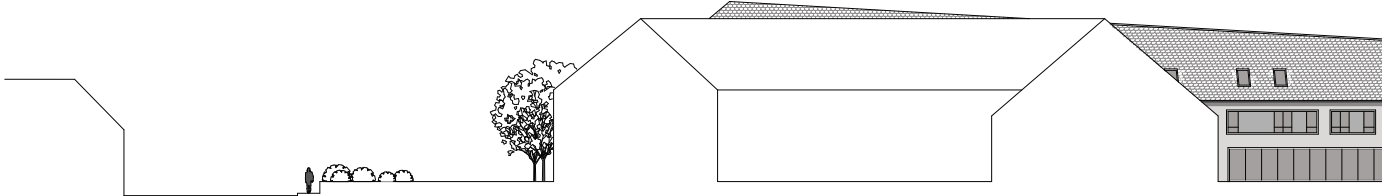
Ansicht West - Einspringer und Zubau mit Schnitt durch das Nachbargebäude - M 1:500
